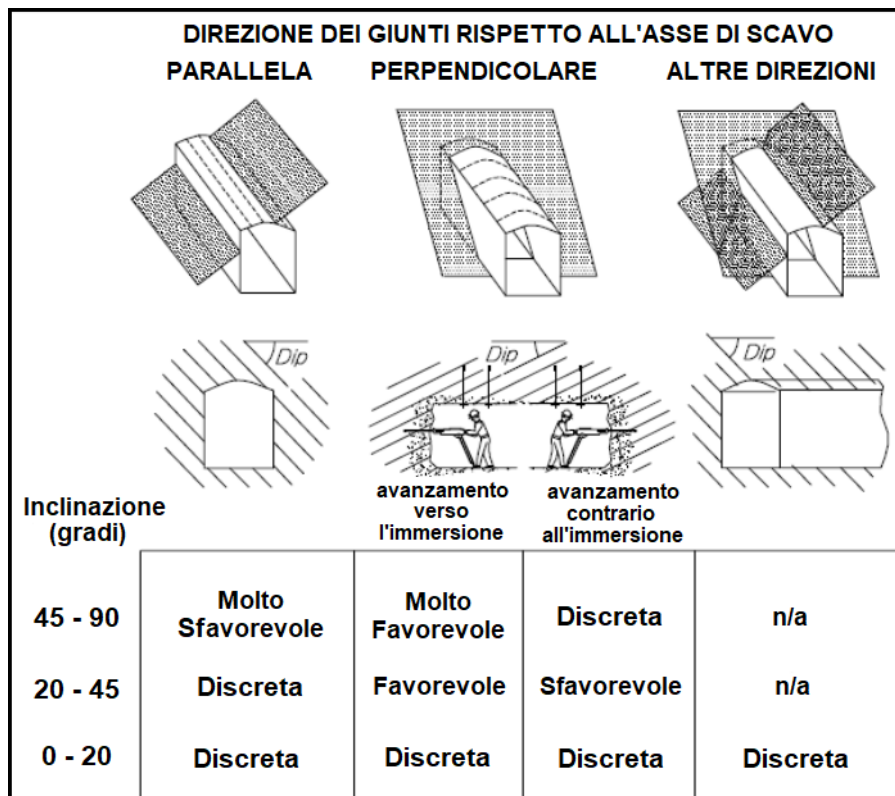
Schema dei rapporti geometrici tra l'asse della galleria e l'immersione delle discontinuità.
